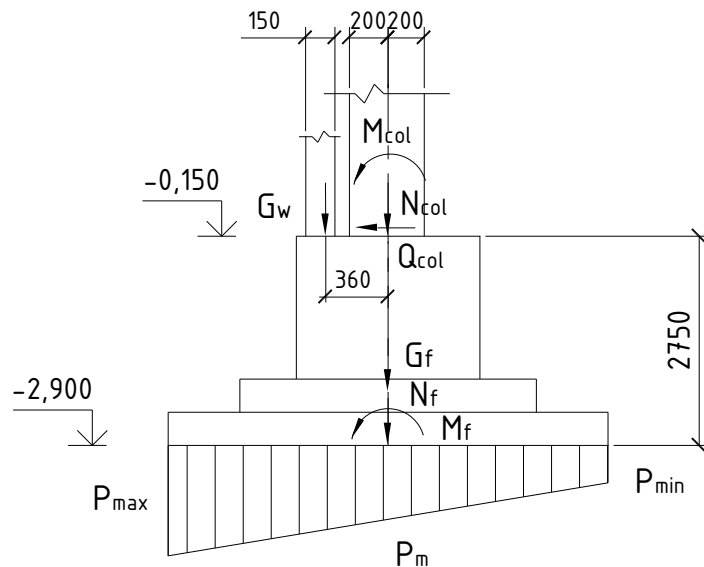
Расчетная схема усилий для фундамента по оси А
